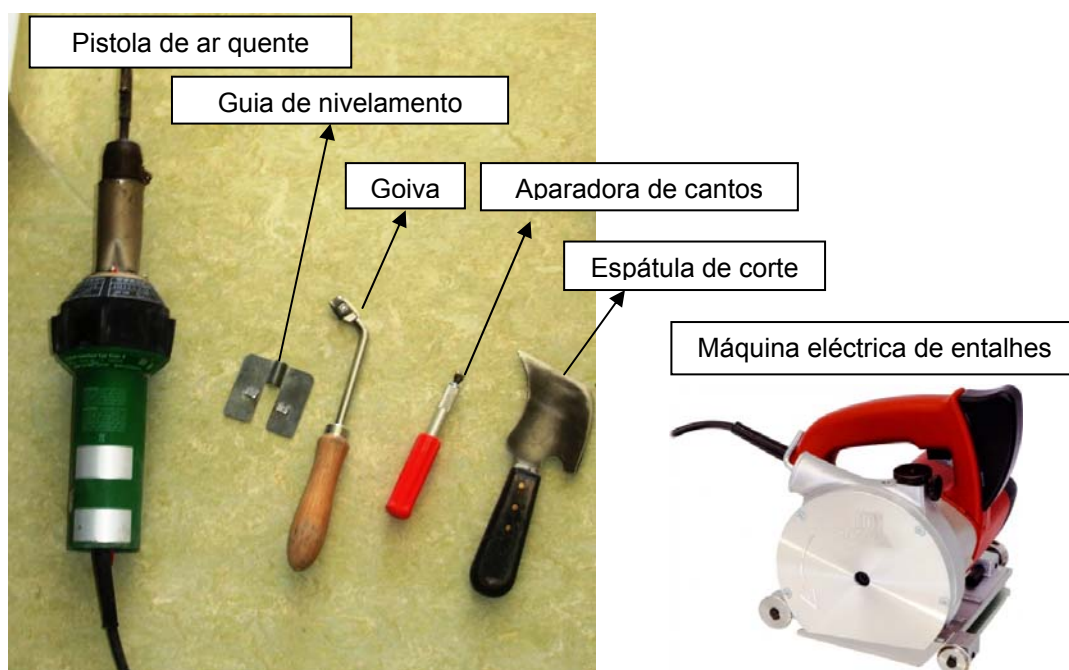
Equipamento necessário para soldadura a quente
